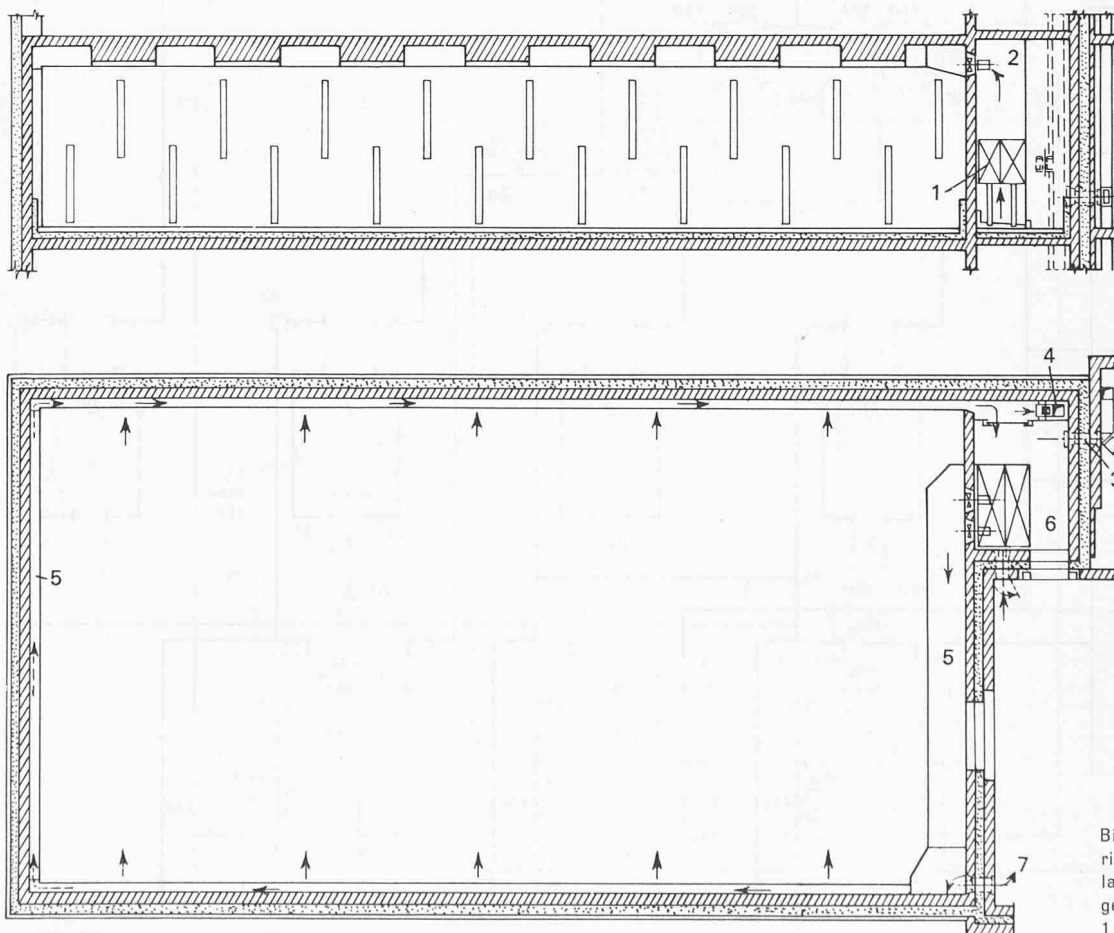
Längsschnitt und Grundriss des Kühl- bzw. Gefrierlagerraumes im dritten Obergeschoss mit Mantelkühlung, 1:200
